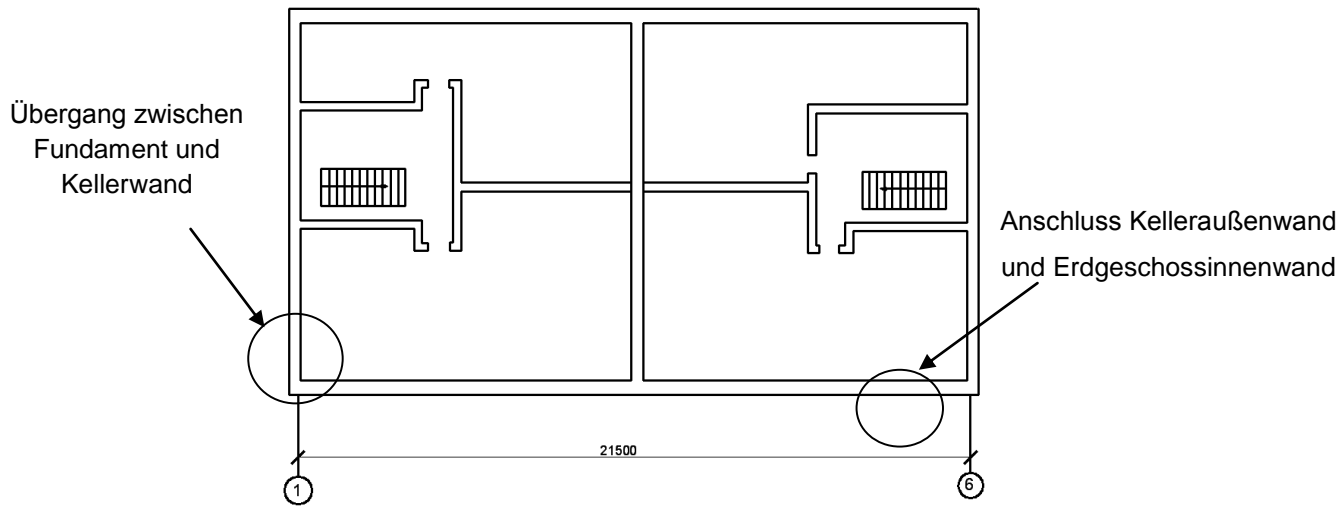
Gebäude in Plattenbauweise der 60-er XX: Grundrisse eines Kellergeschosses
